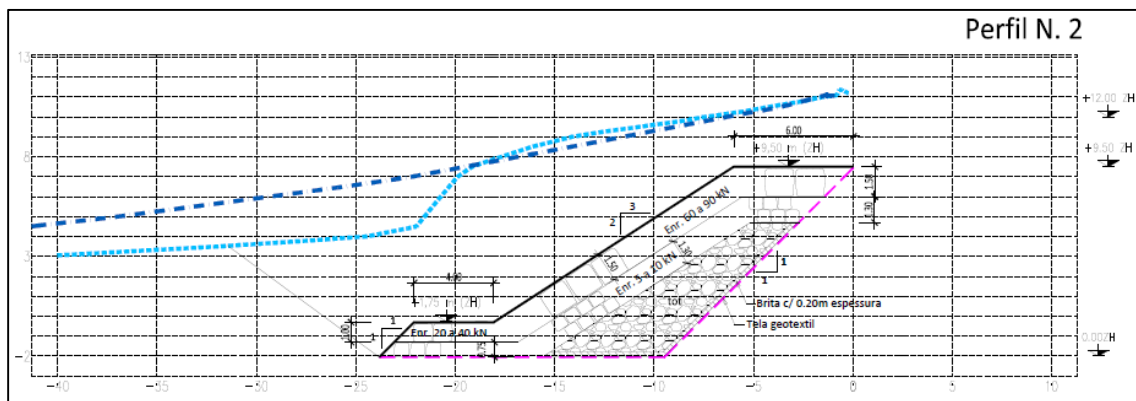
Troço do Centro Azul – Perfil 2 (fonte: APA, fevereiro de 2014)
